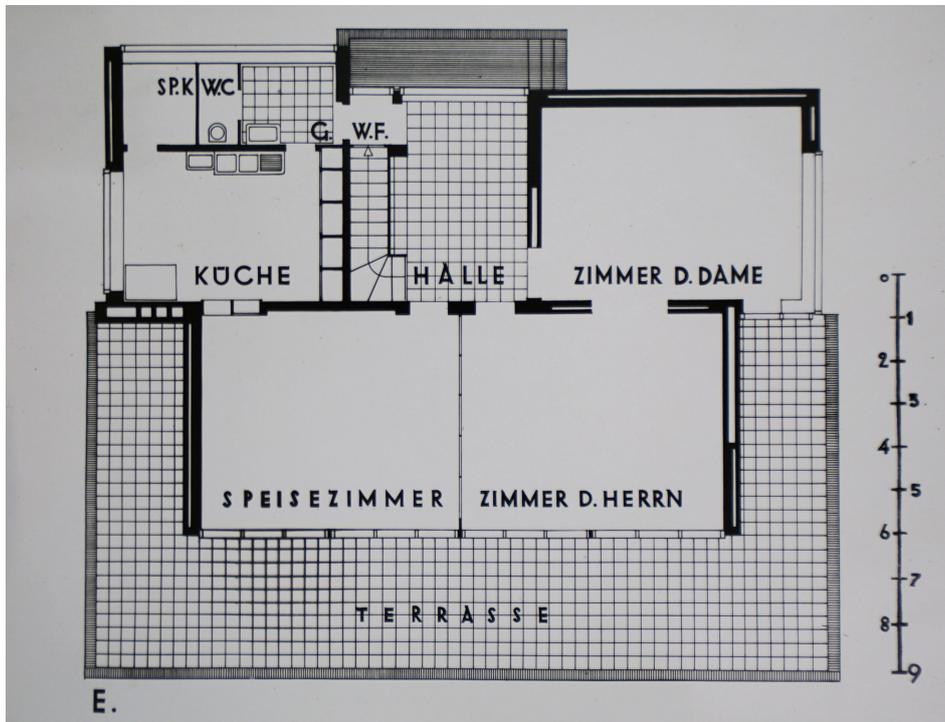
Grundriss Erdgeschoss, Publikationsplan, ohne Datum
